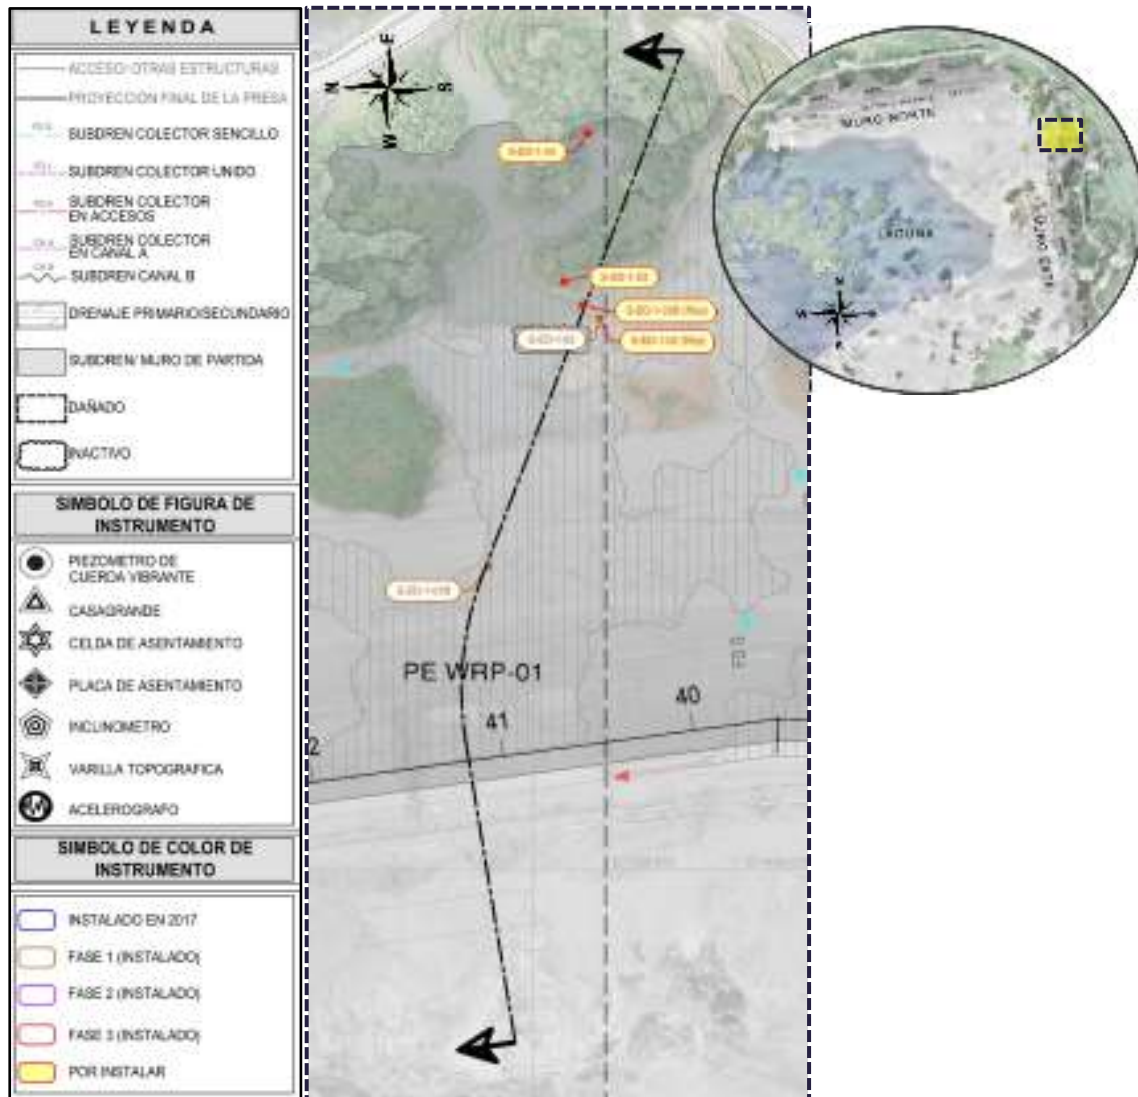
Vista de Planta en el Muro Este WRP1 con las Celdas de Asentamiento
